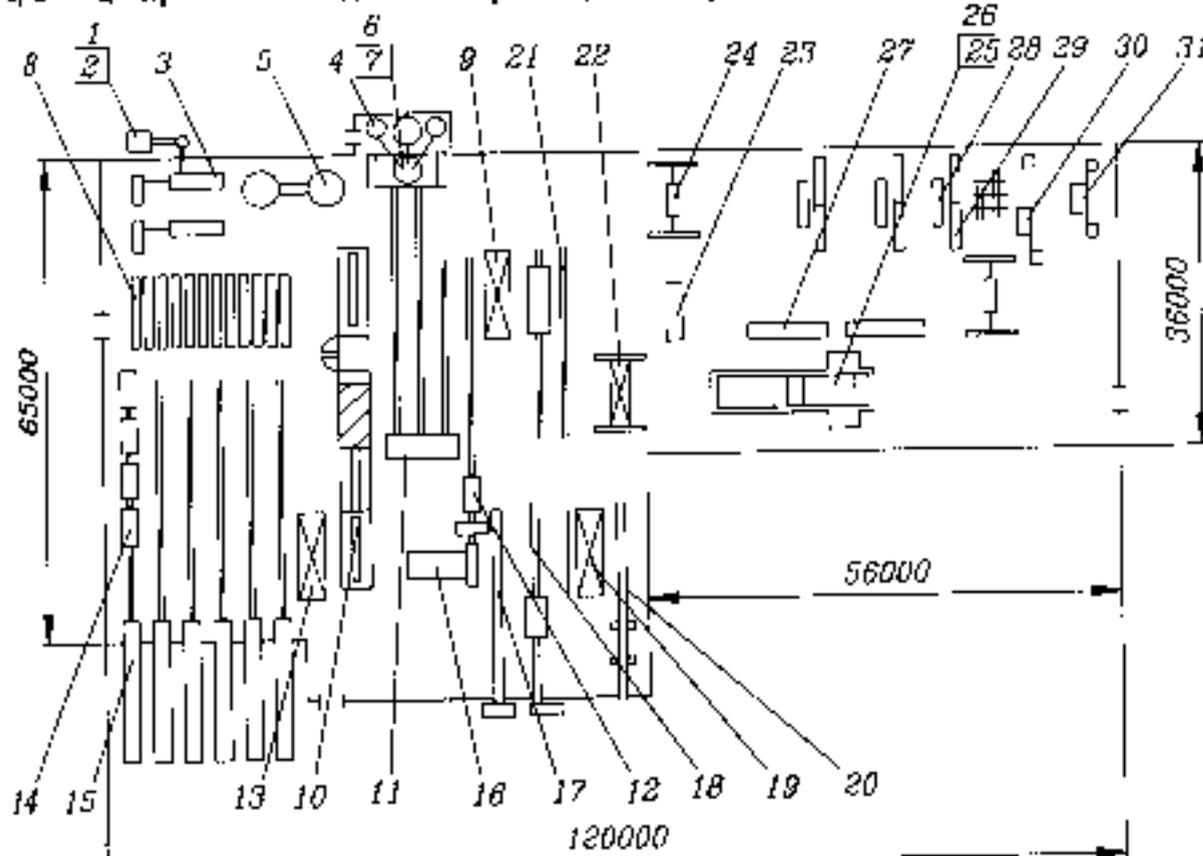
План производственного корпуса с агрегатно-поточной линией АПЛ-180. 1 — приемные емкости для песка и извести; 2 — питатель ленточный; 3 — мельницы шаровые;
